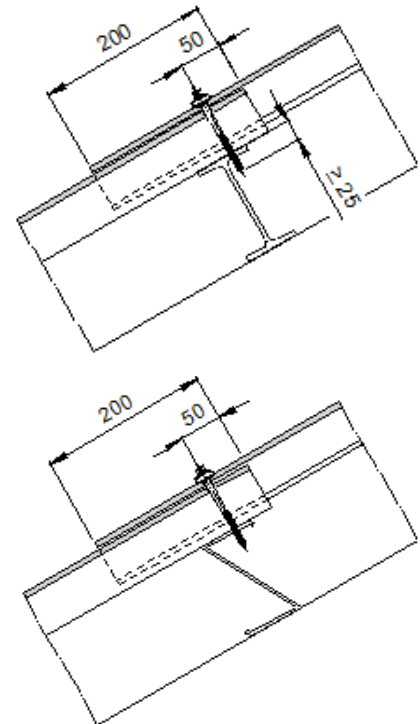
Befestigung auf einer Stahl- und/oder Aluminiumpfette (z.B. Z-Profil) mit Bohrbefestiger
